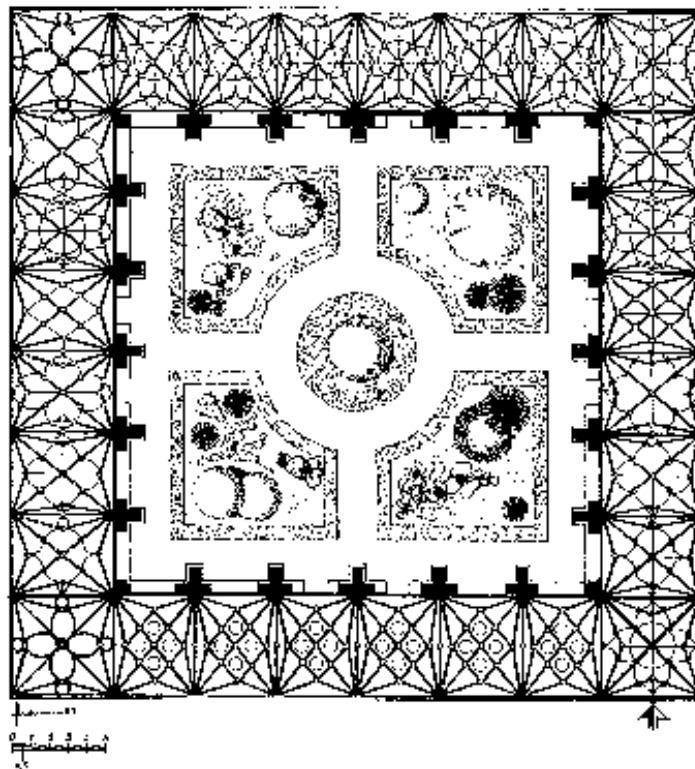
León. San Marcos. Planta del claustro (Campos).
